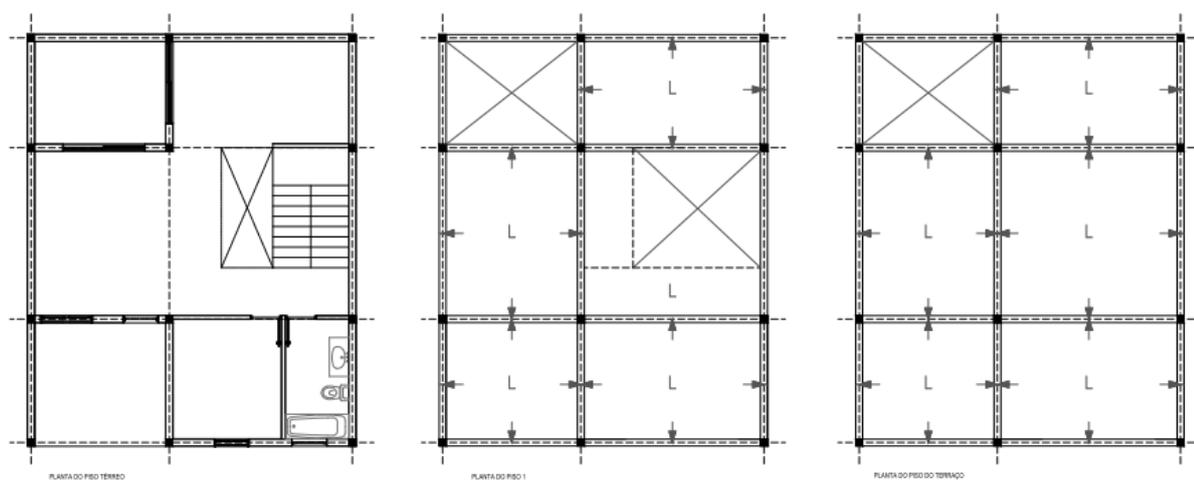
Representação esquemática em planta do sistema construtivo de alvenaria tradicional
